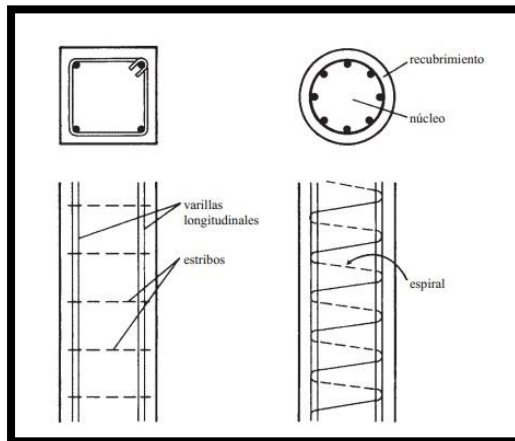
Detalle de refuerzo en columnas rectangulares y circulares (McCormac, Jack C., Brown, H. Russell, Estados Unidos (2011). “Diseño de Concreto Reforzado”, Capítulo 9, Sección 9.2, Figura 9.2 (a) y (b)).
